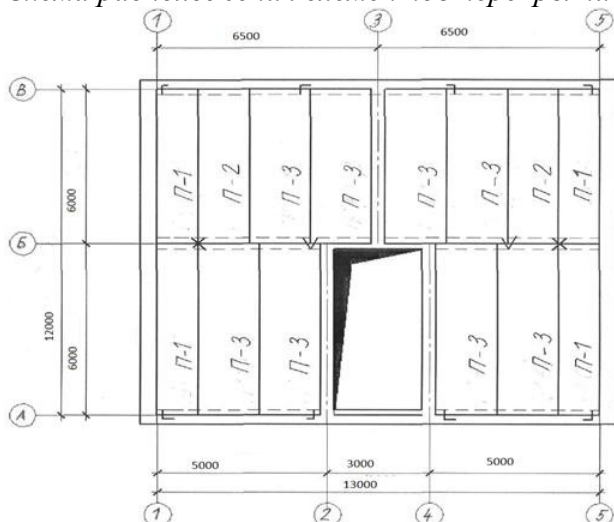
Пример выполнения схемы расположения плит междуэтажного перекрытия
